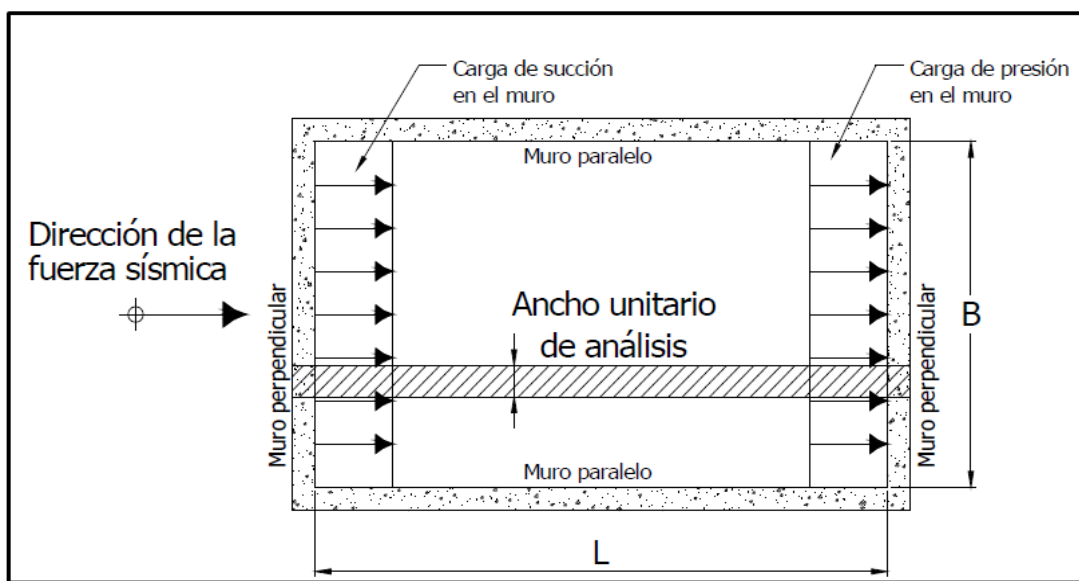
Distribución hidrodinámica en los muros del tanque - corte en planta. Adaptado de: ACI350.3-06
